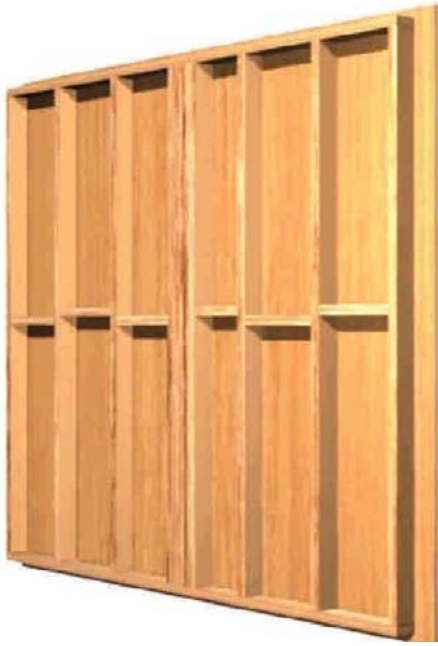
1: Elevación de un tabique soportante de madera prefabricado, cuyo diseño considera como componente arriostrante la utilización de tablero contrachapado o de hebras orientadas (OSB). Vista por el interior
